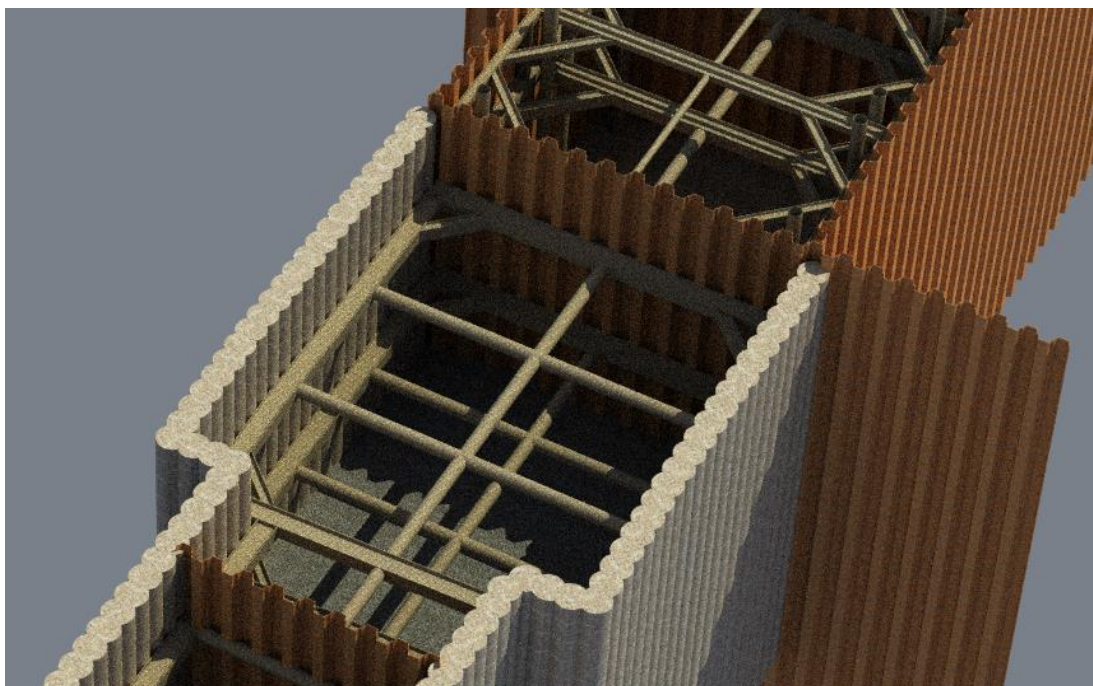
Baugrube Abschnitt Strandbad, Bohrpfähle und Spriessung
